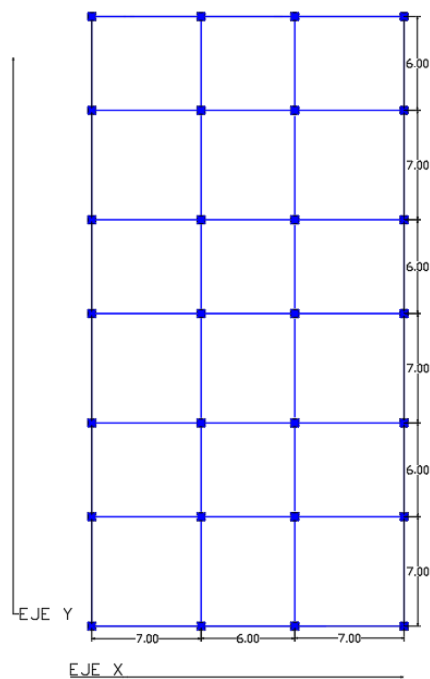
Modelo 1 en planta y Distribución de columnas.
